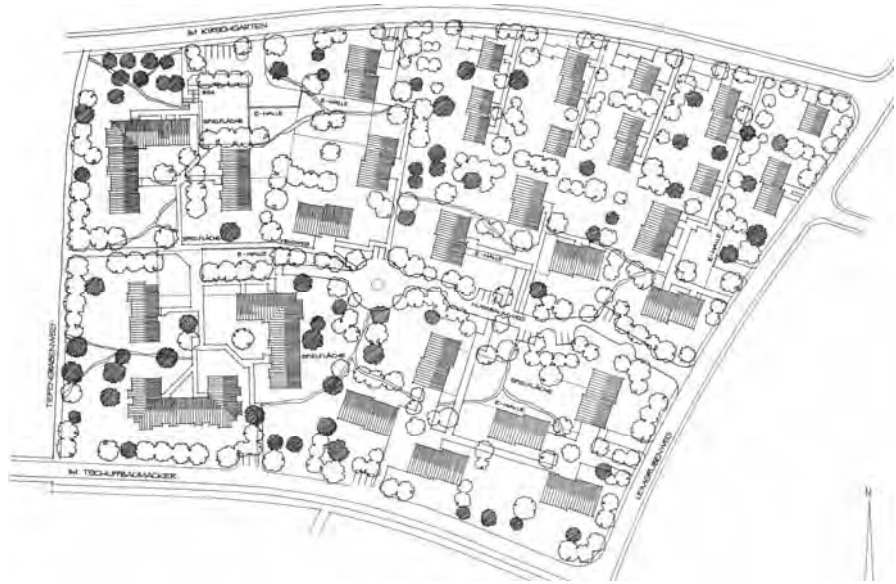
Rechtsgültiger Quartierplan „Kirschbaumacker“, Gestaltungsplan
